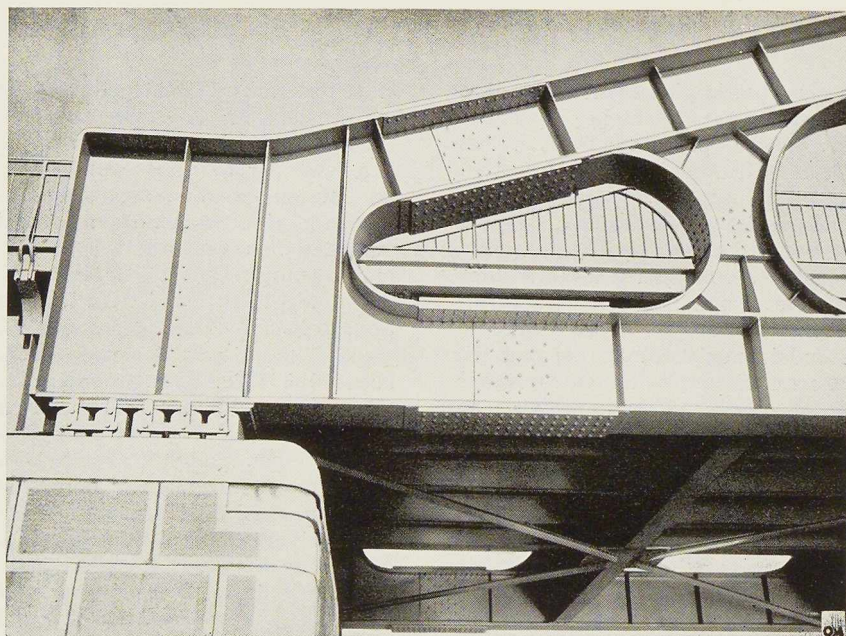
Détail des poutres Vierendeel du pont de Schoten.
